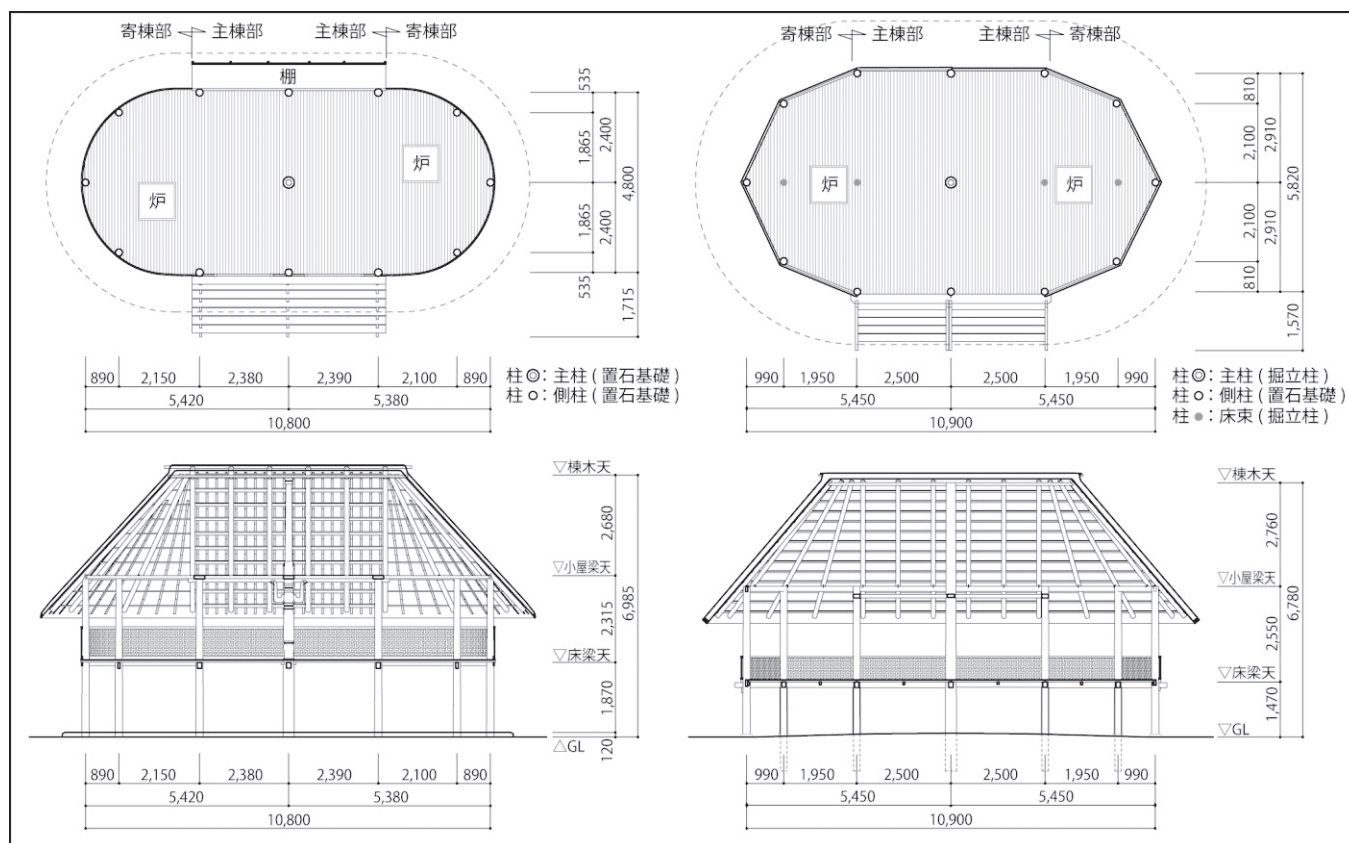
平面図・断面図 (左: TQ 社, 右: TL 社)
